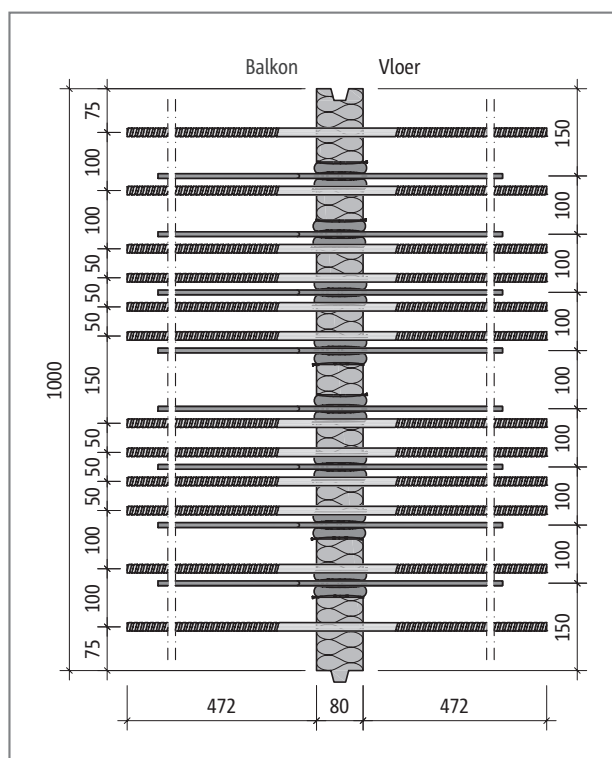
Schöck Isokorb® CT type K-T-M2-V1-CV30: doorsnede
